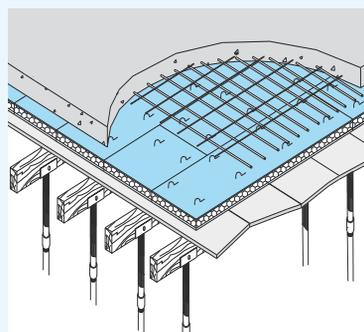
Support continu : ferrailage et coulée du béton sur panneaux agrafés
